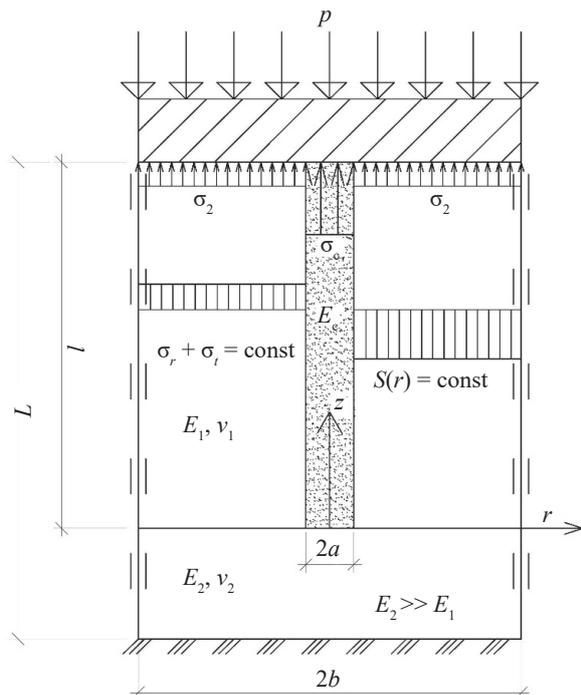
Расчетная схема щебеночной сваи с окружающим грунтом и ростверком по схеме «свая – стойка»
